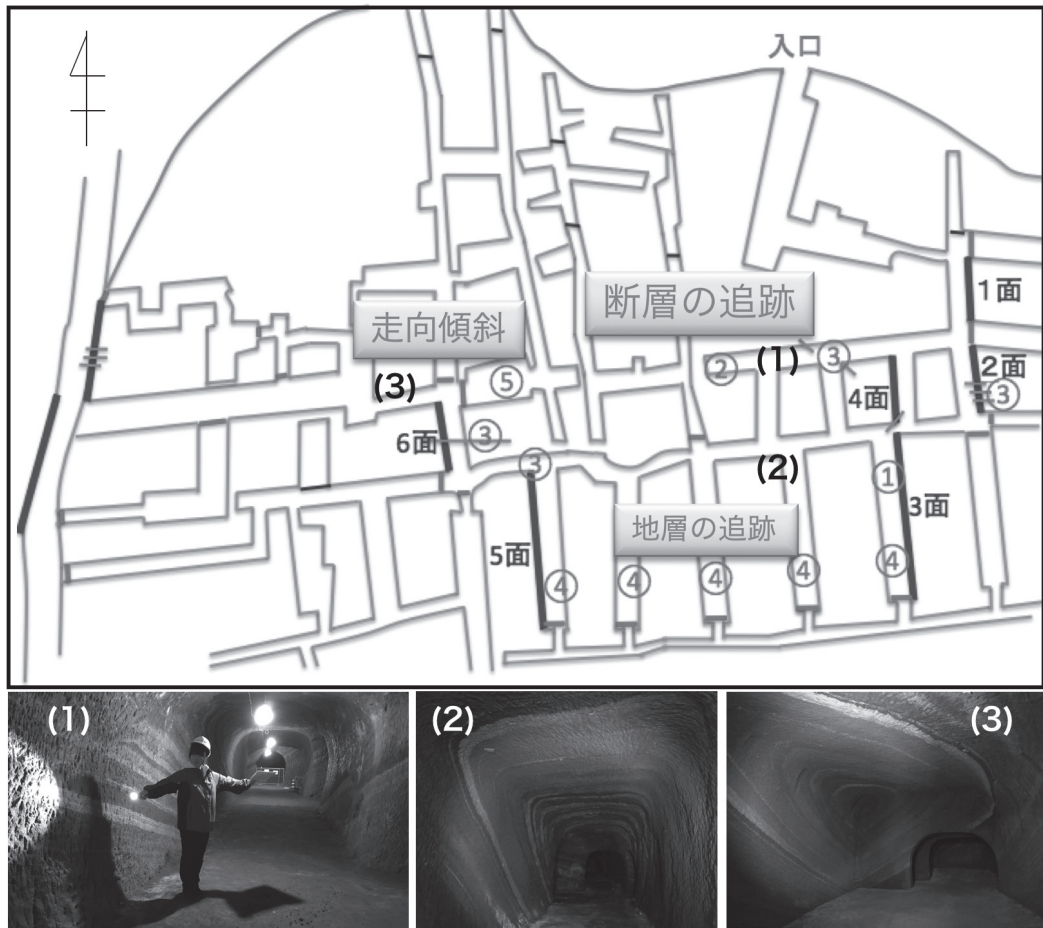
赤山地下壕 上：平面図 下：平面図の(1)～(3)地点
